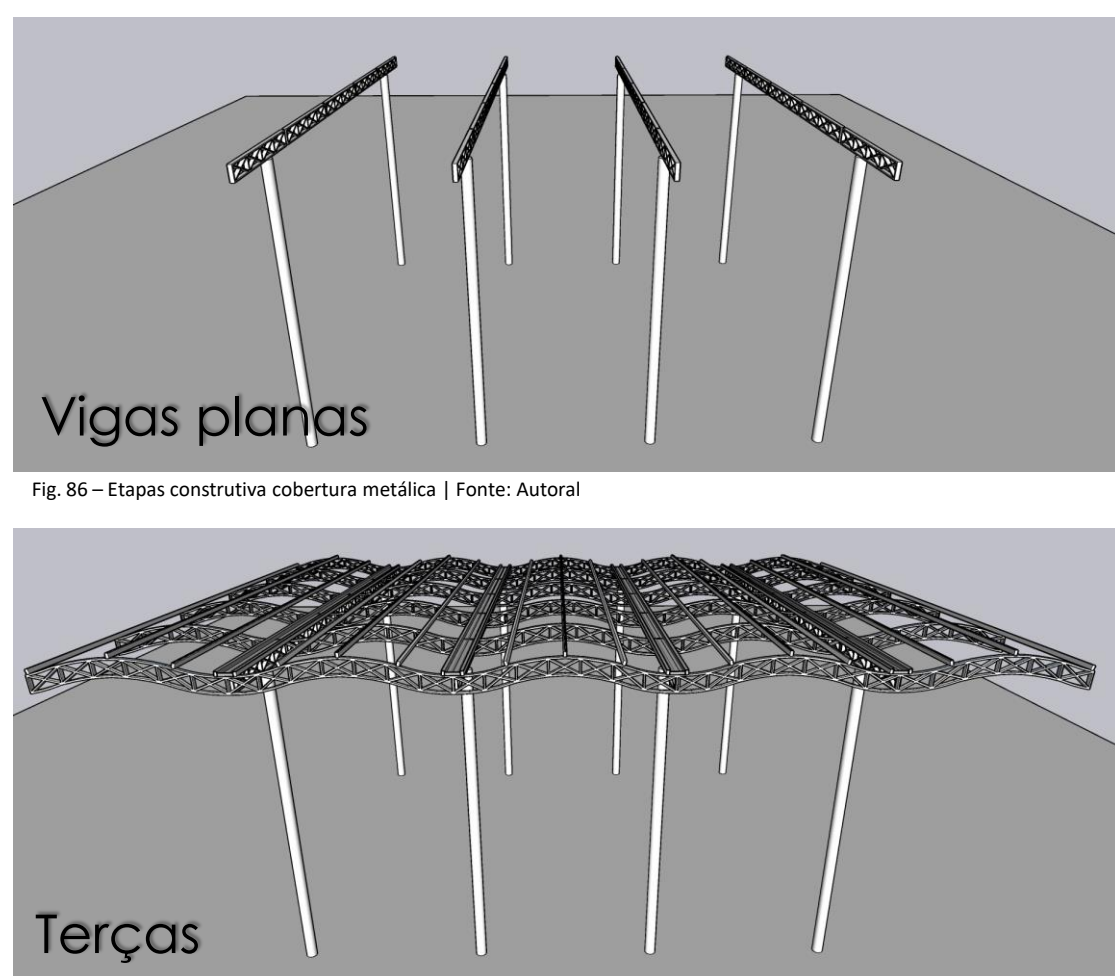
Etapas construtiva cobertura metálica | Fonte: Autora
